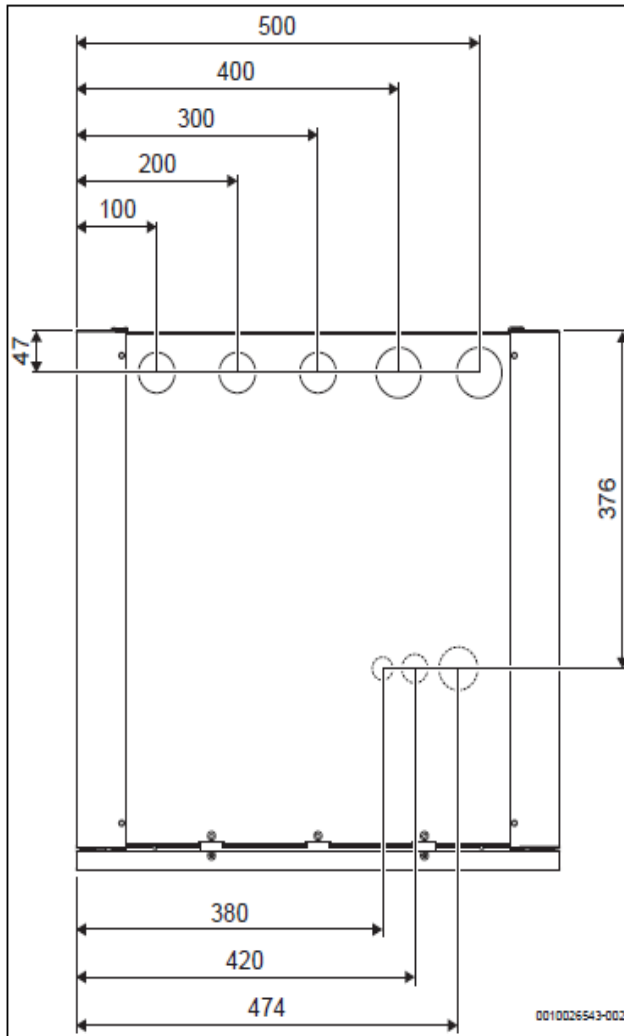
CS7800i LW ... (F)/CS7800i LW ... MB(F) – Anschlussabmessungen, Draufsicht (Maße in mm)
